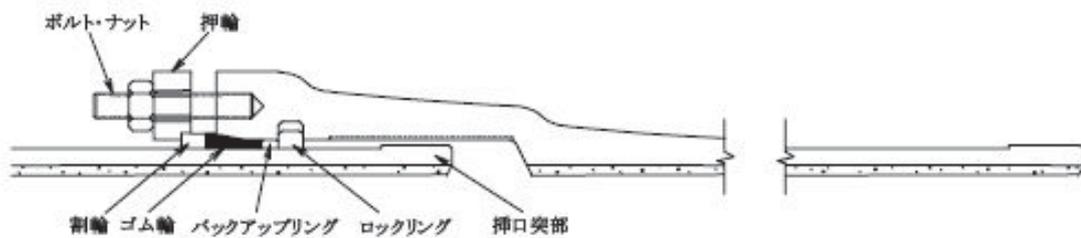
弾性継手の例 (S型ダクタイル鋳鉄管の継手)
